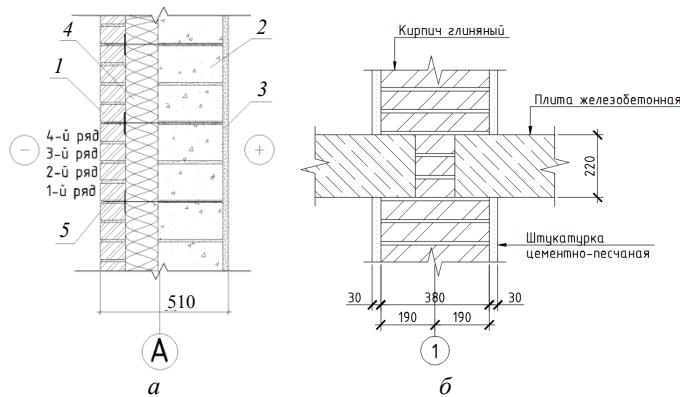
Конструктивное решение стен: *а* – трехслойной наружной стены здания из блоков с внутренним слоем утеплителя и облицовочным слоем из кирпича (выполнила студентка Н.П. Белоногова, гр. ПГС-11-1); *1* – кирпичная кладка; *2* – блочная кладка; *3* – штукатурка; *4* – утеплитель; *5* – гибкие стеклопластиковые связи с фиксаторами; *б* – внутренней несущей стены (выполнил студент В.С. Пономарев, гр. ПГС 13-26)
